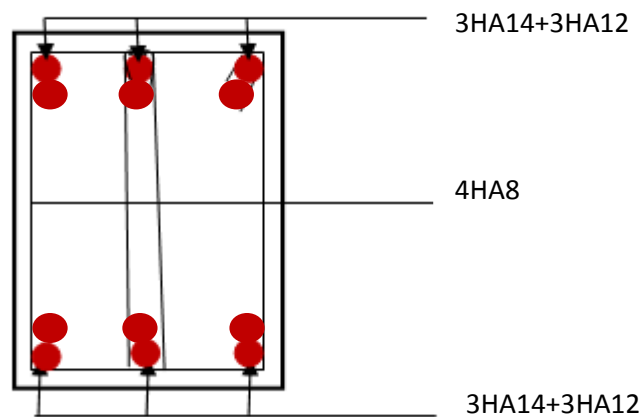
Ferrailage sur appuis d'une poutre secondaire
